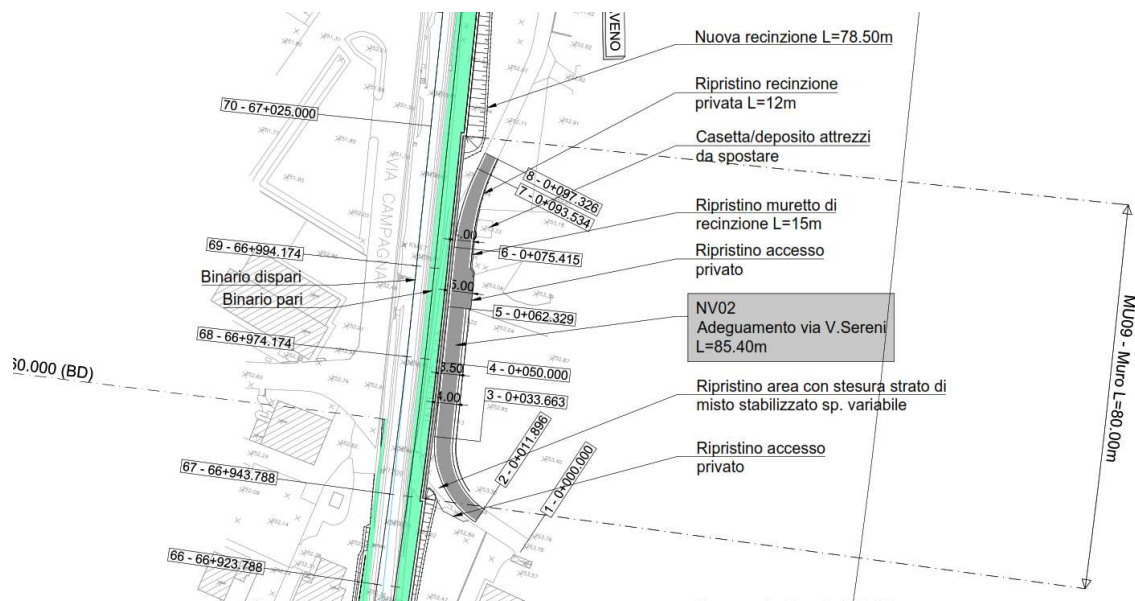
Planimetria di progetto adeguamento via Sereni.
